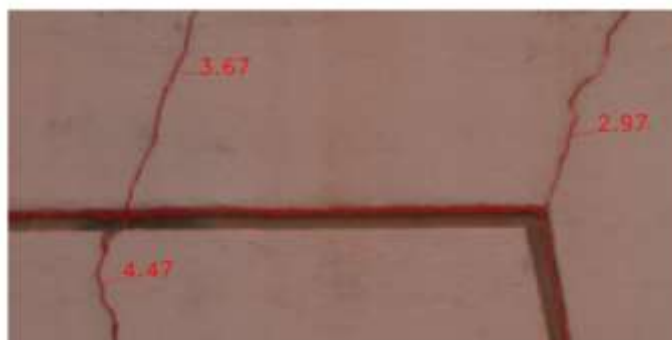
Вычисленные значения ширины раскрытия трещин на ортофотоплане (фрагмент)
